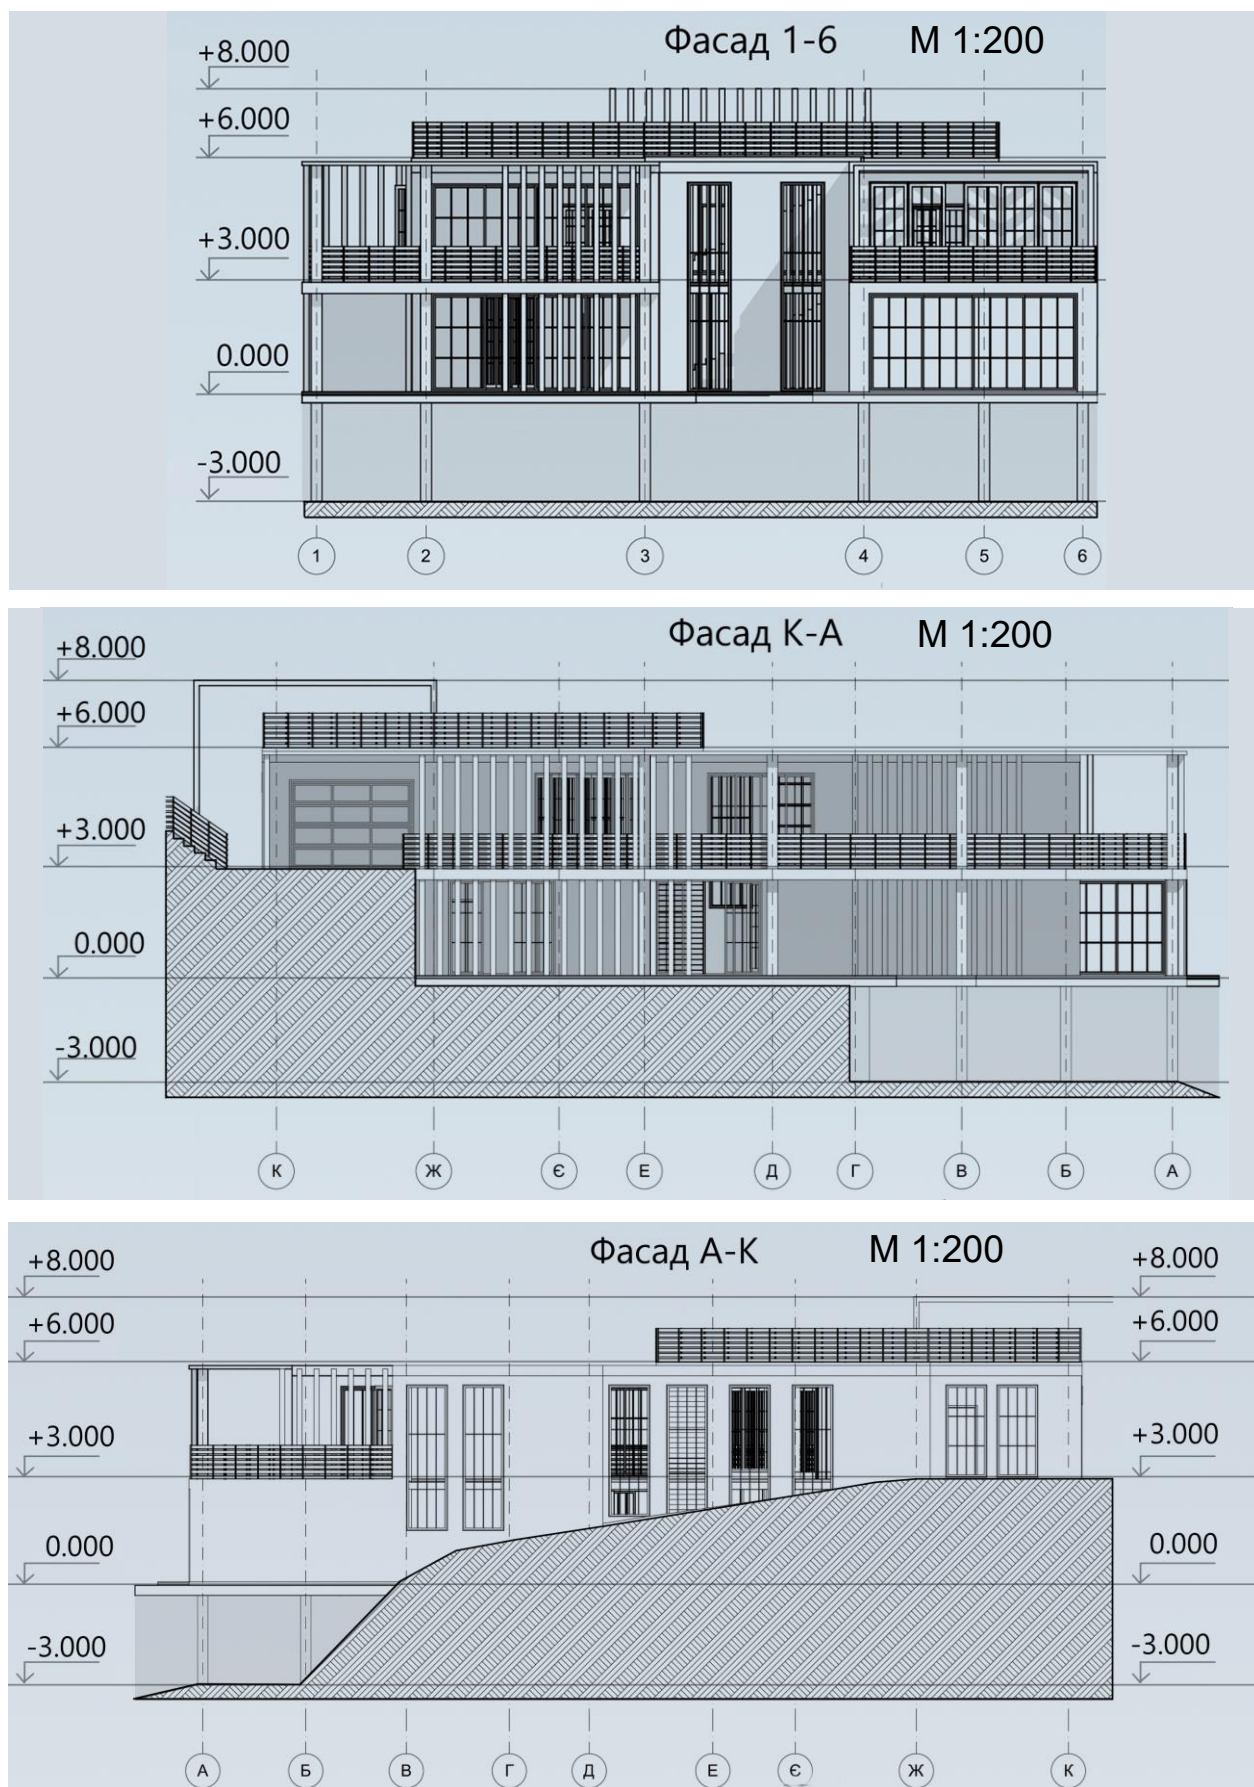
Приклад оформлення фасадів сучасної житлової будівлі
